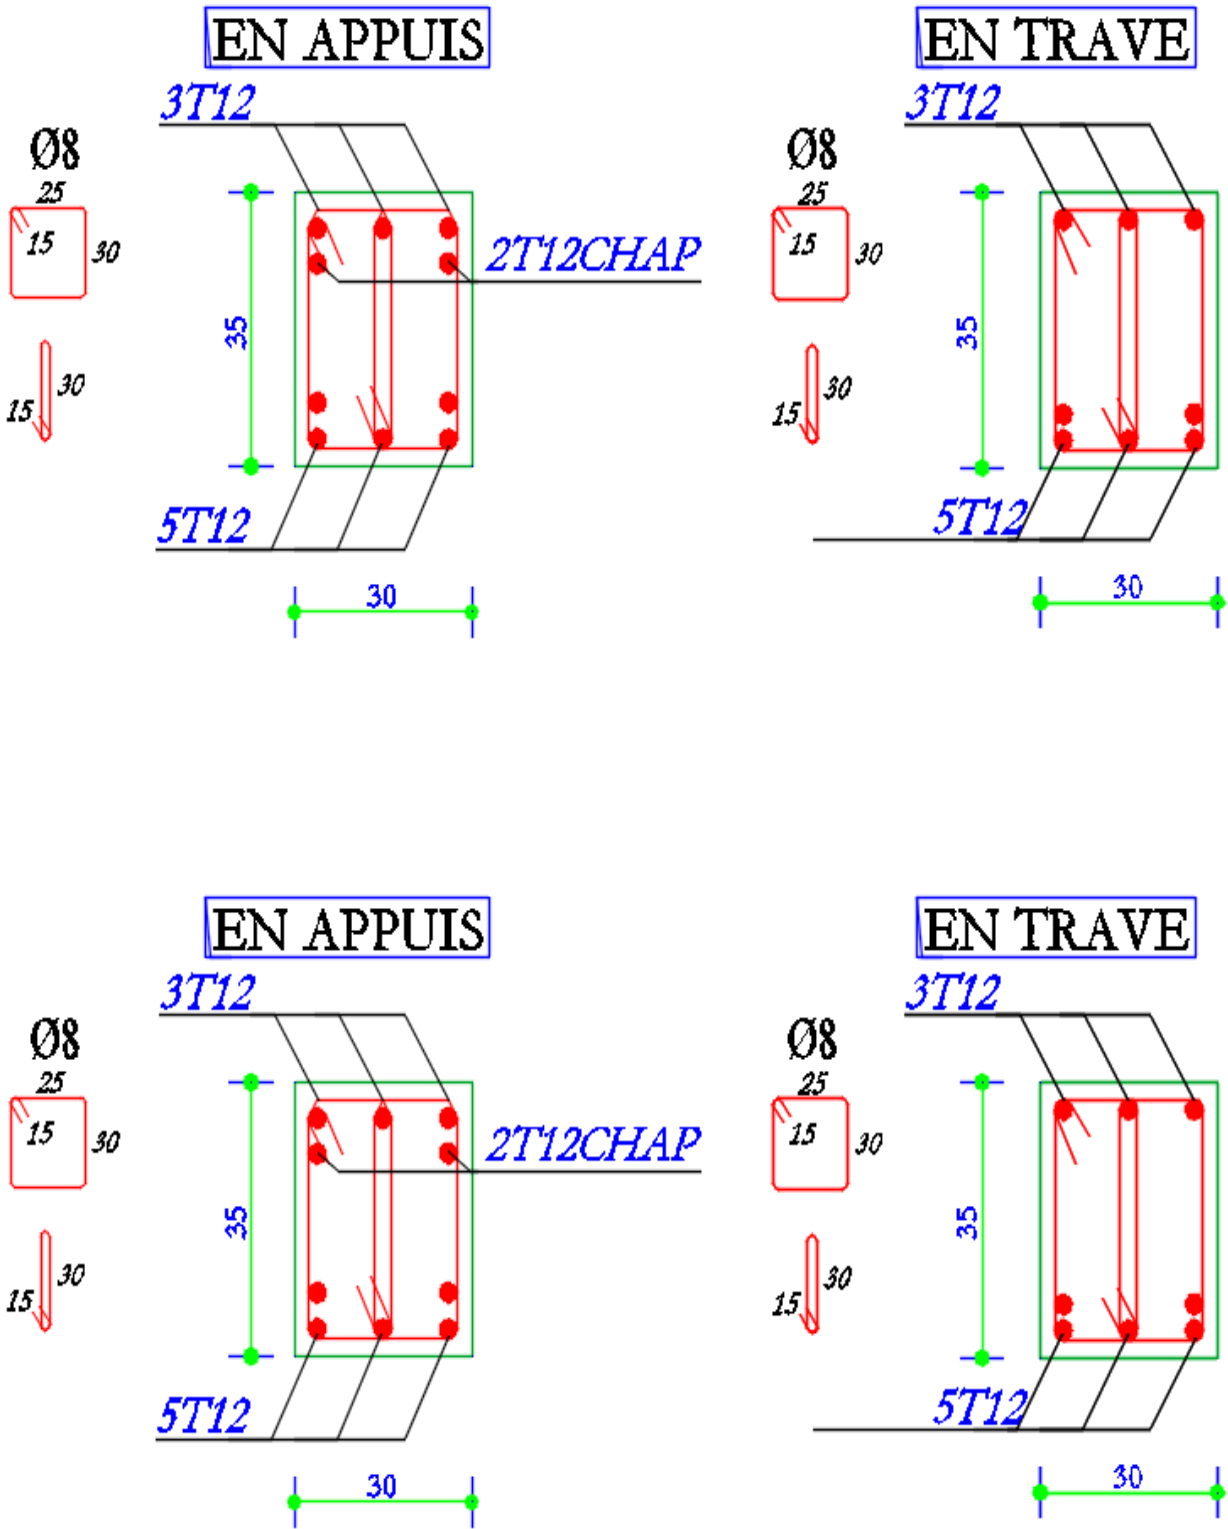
Schéma de ferrailage des poutres principales dans les différents étages.
